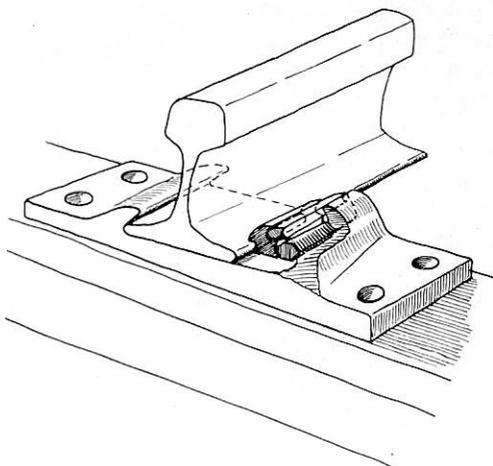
Bauform des Selbstspannüberbaues mit Ausgleichkeil für die Walzabmaße bei unbearbeiteten Schienen und Platten.
